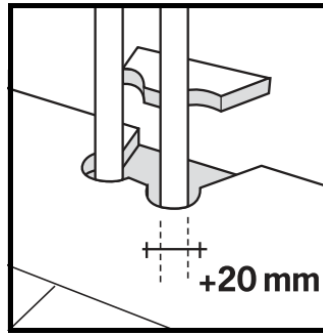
Remate em zona de passagem de tubos. [34]
